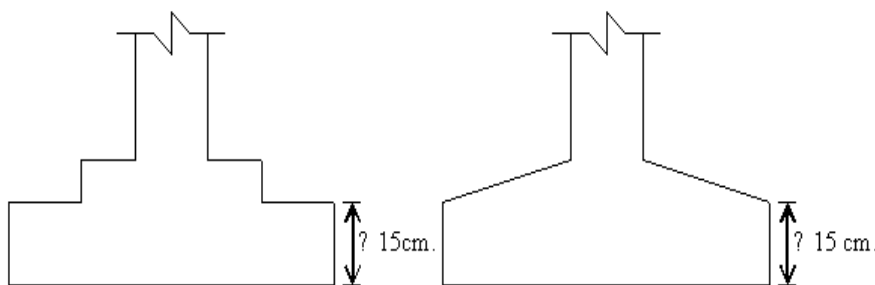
Zapatas aisladas de peralte variable.
